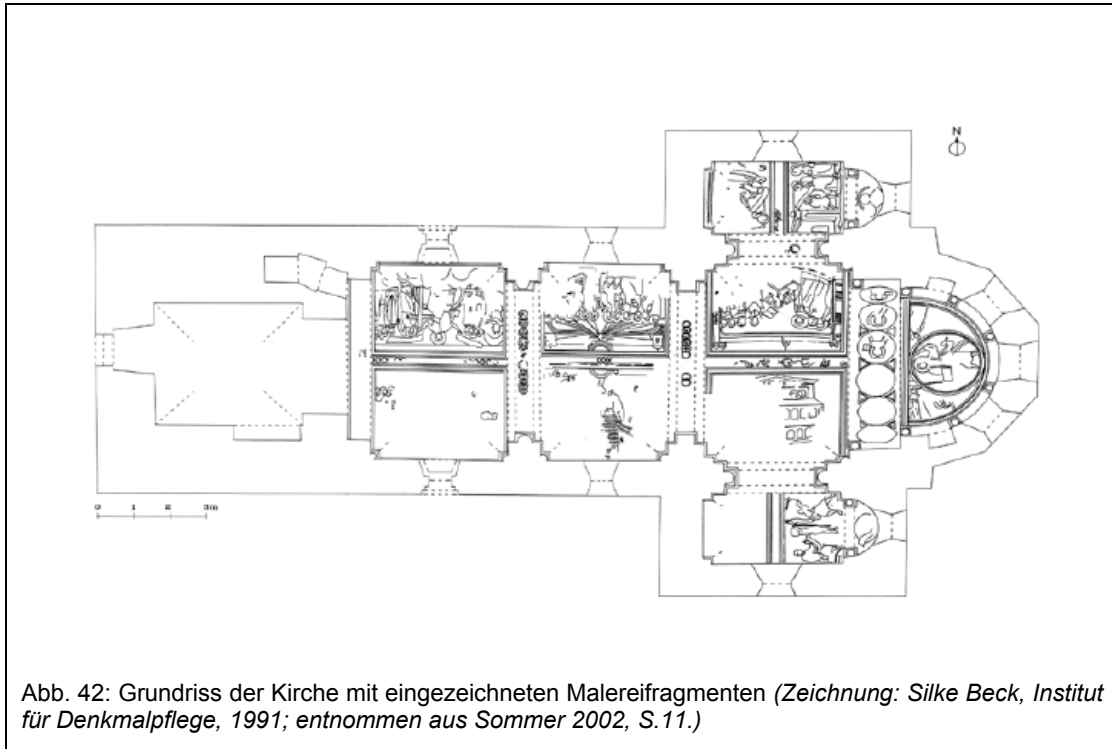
Grundriss der Kirche mit eingezeichneten Malereifragmenten (Zeichnung: Silke Beck, Institut für Denkmalpflege, 1991; entnommen aus Sommer 2002, S.11.)
